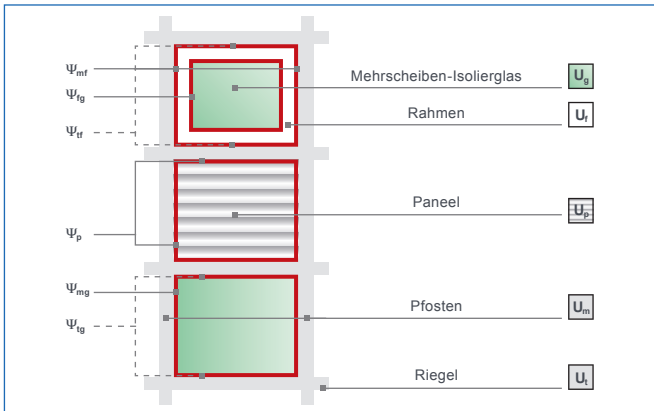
Musterfassadenelement gemäß EN ISO 12631 [3].
